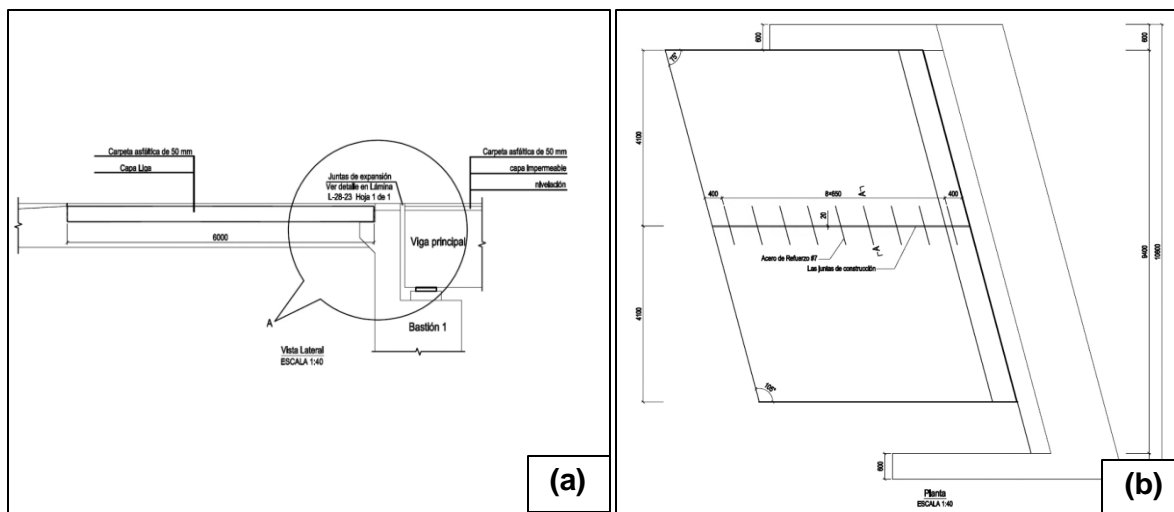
Detalle de la losa de aproximación del puente nuevo sobre el río Escondido (puente con sesgo de 15°). (a) Vista en elevación. (b) Vista en planta.
